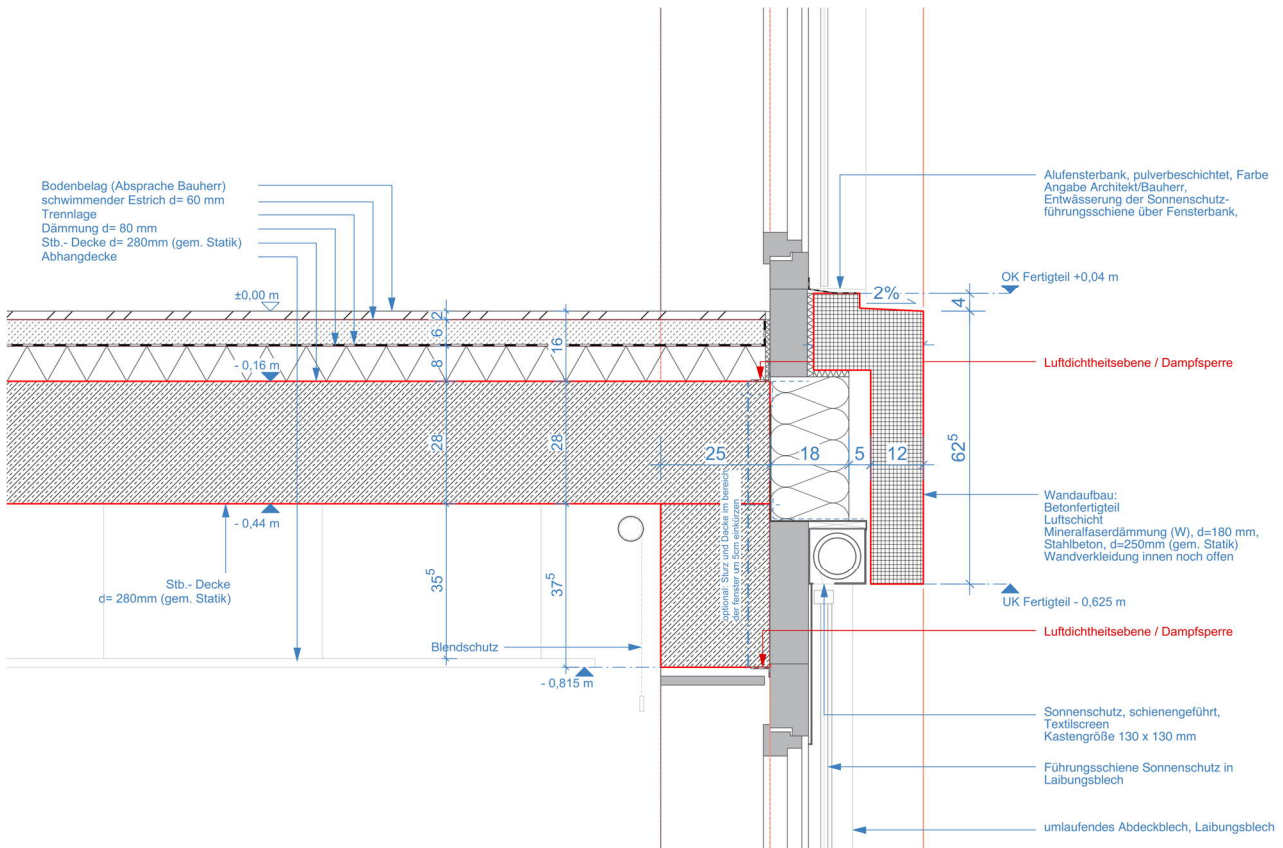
Leitdetail Geschossdecke/Fassade_ursprüngliche Planung
